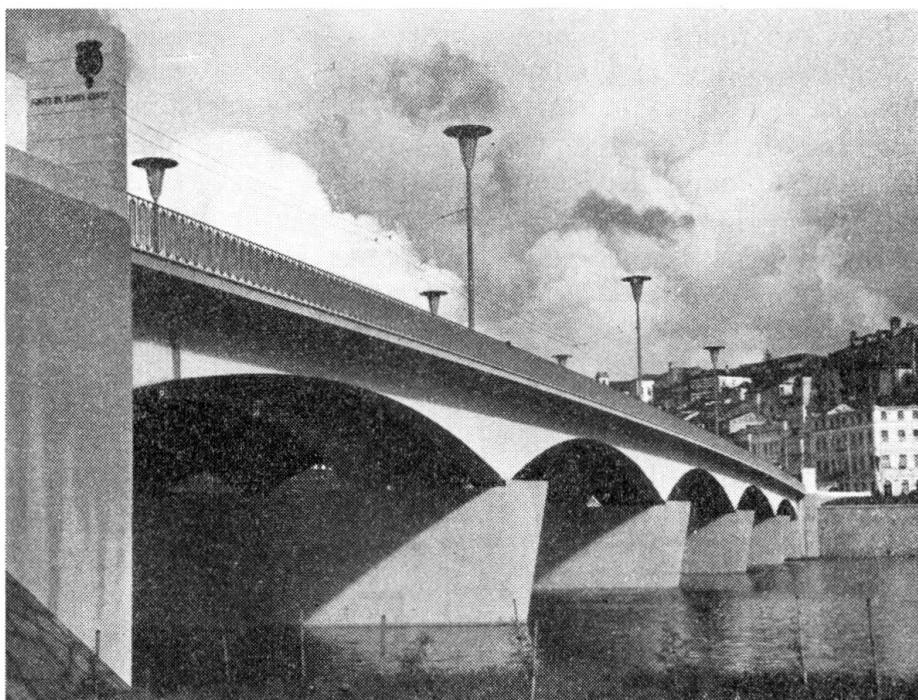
Ponte de Coimbra (Santa Clara), terminada
